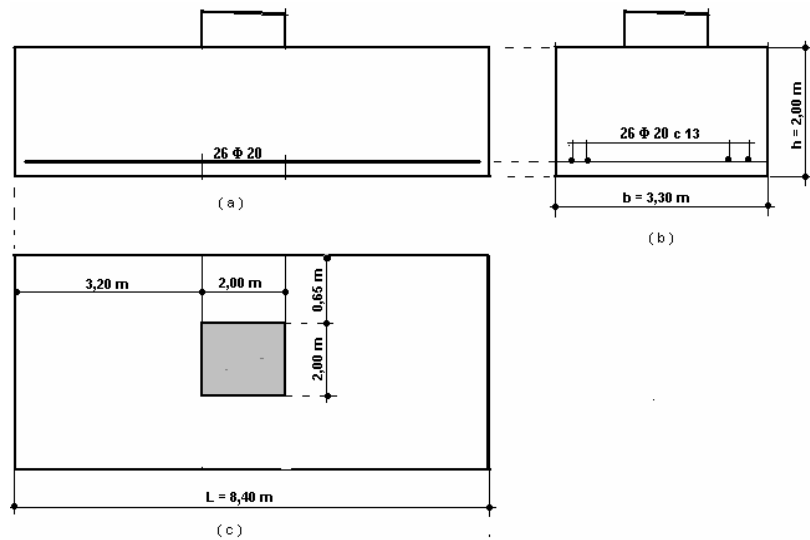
Bloco 1: a -) Elevação; b -) Seção; c -) Planta baixa
